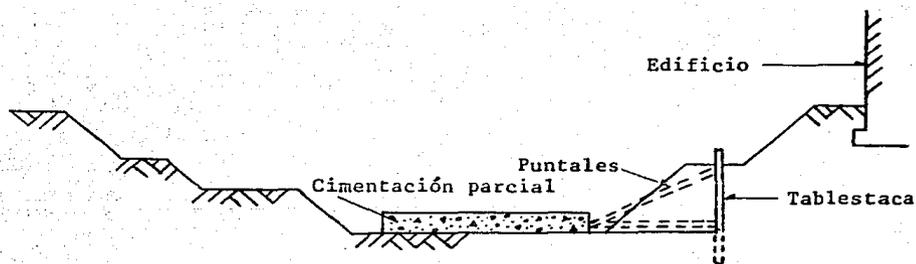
APUNTALAMIENTO INCLINADO.
